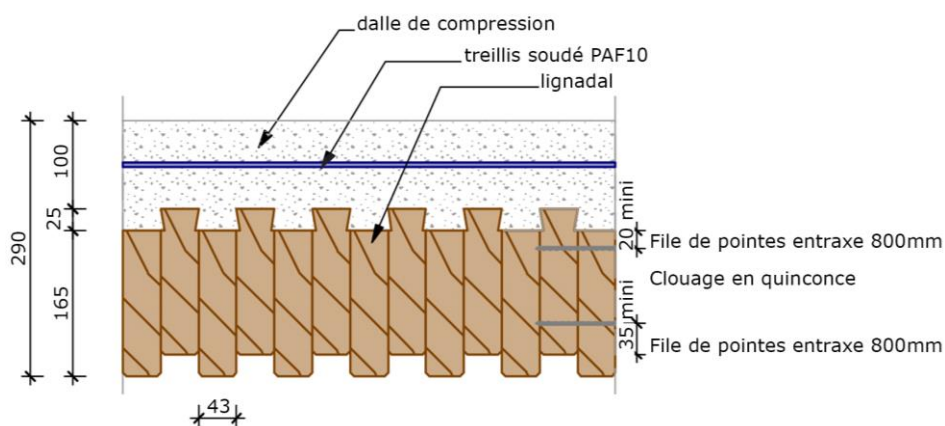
Coupe sur le plancher intermédiaire bois béton de l'extension de la coopérative forestière et du bâtiment lycée - source : Lignatech, fabricant
